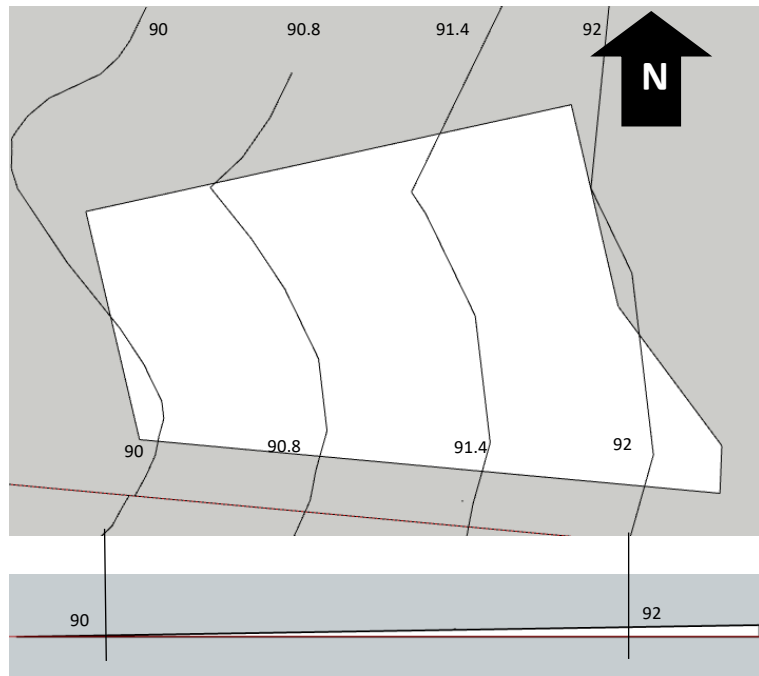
Planta y corte seccional de la topografía del proyecto,
